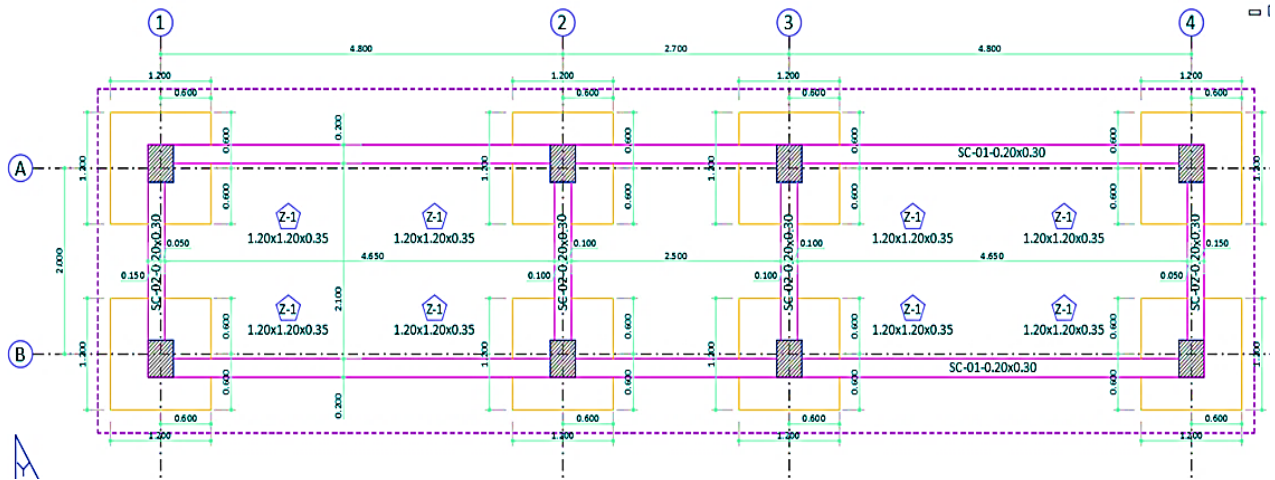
Planta de cimentación. Fuente Estudios y diseños contrato 1318-2013
